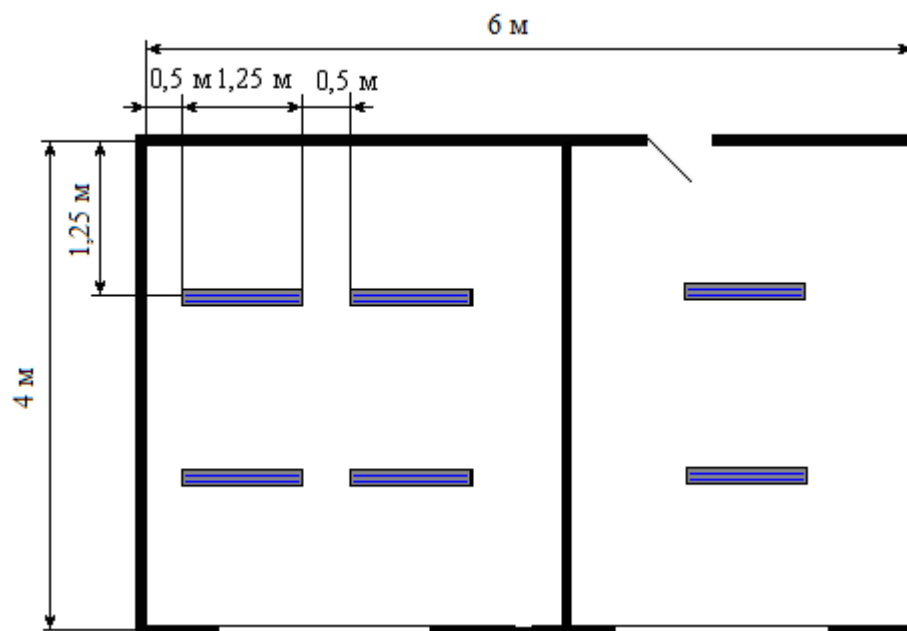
Схема размещения светильников (вид сверху)
